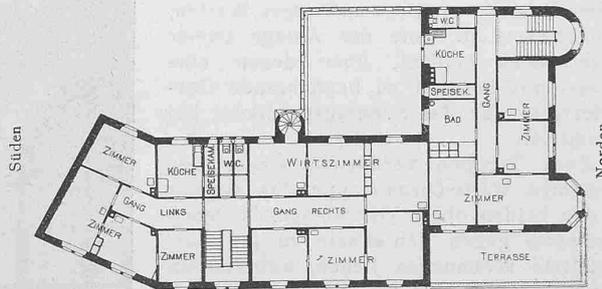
Grundriss vom Obergeschoss. — Masstab 1 : 500.
